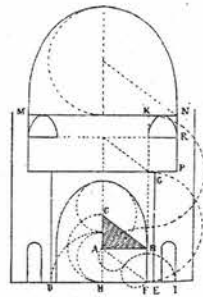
Coupe transversale de la salle C, pl. III (Épure de construction).
